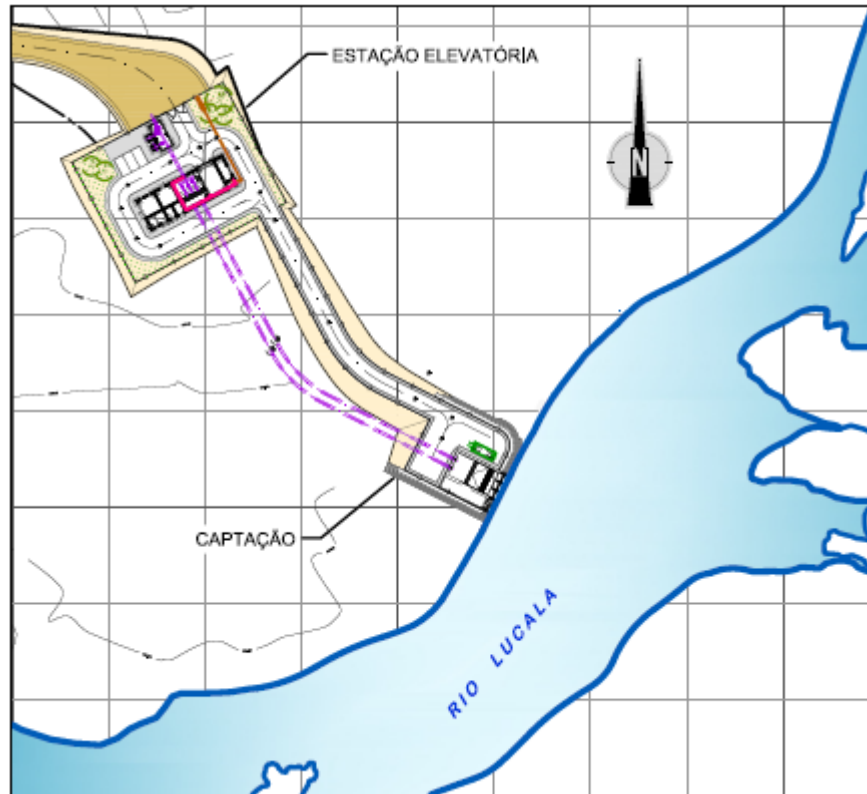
Implantação da Captação e Estação Elevatória.
